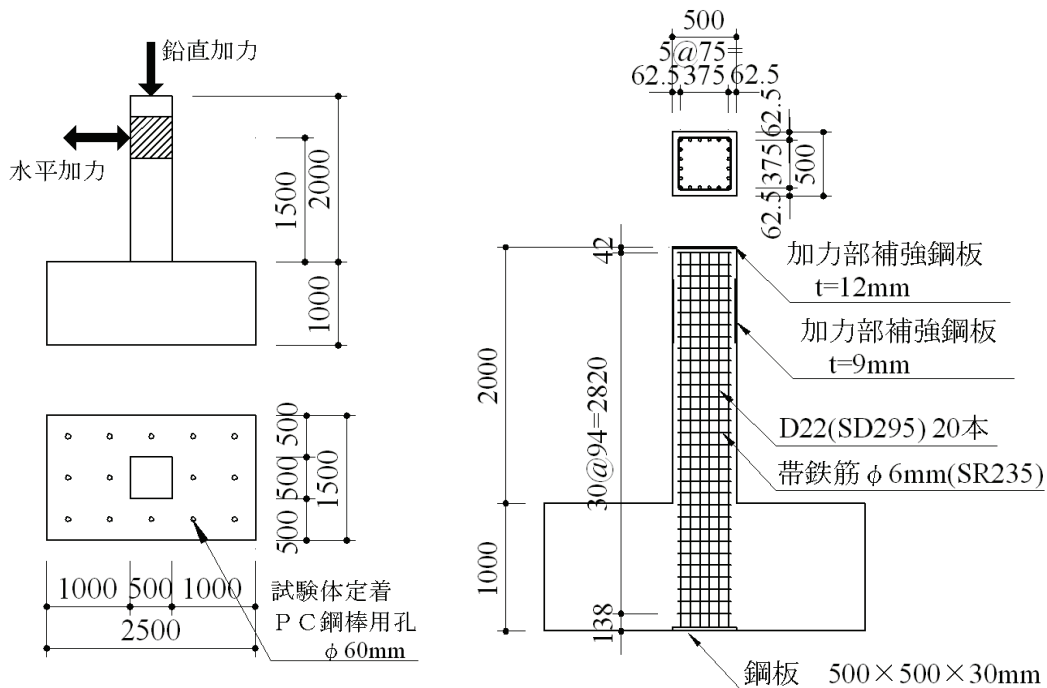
試験体構造図・配筋図 (単位 mm)
